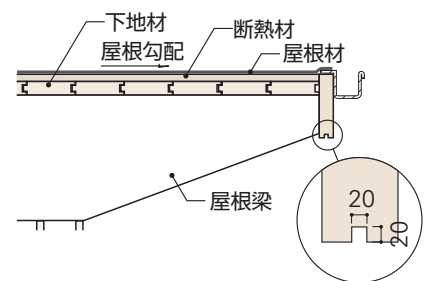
鼻隠し下部に水切り溝を設ける例(American Institute of Timber Construction, AITC Technical Note 108-84, 1984より作図)
